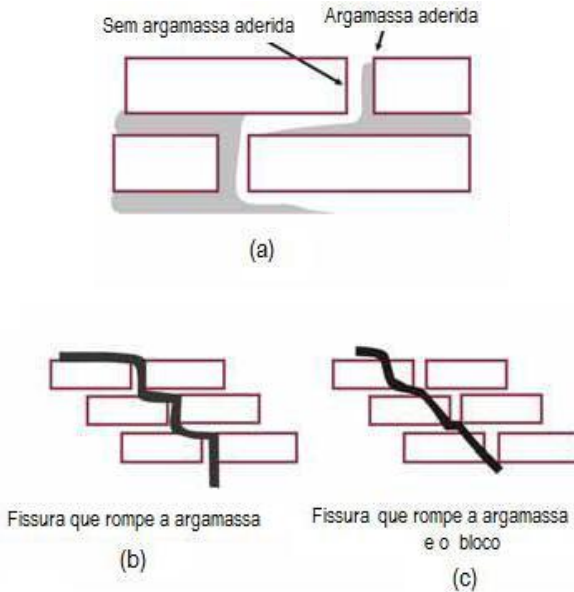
Trajetória de fissuras em paredes de alvenaria.
